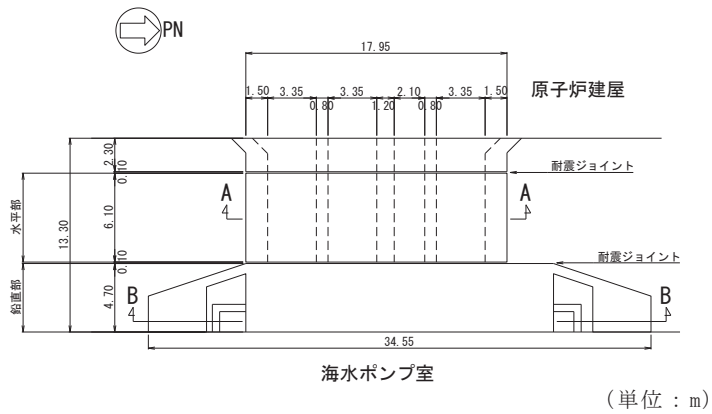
原子炉機器冷却海水配管ダクト平面図
